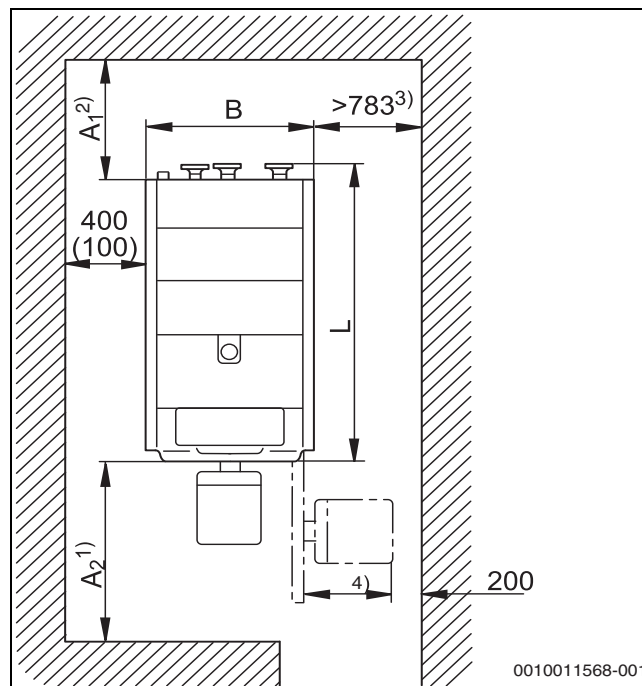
Medidas do local de instalação em mm (→ Tabela 10, página 17)
